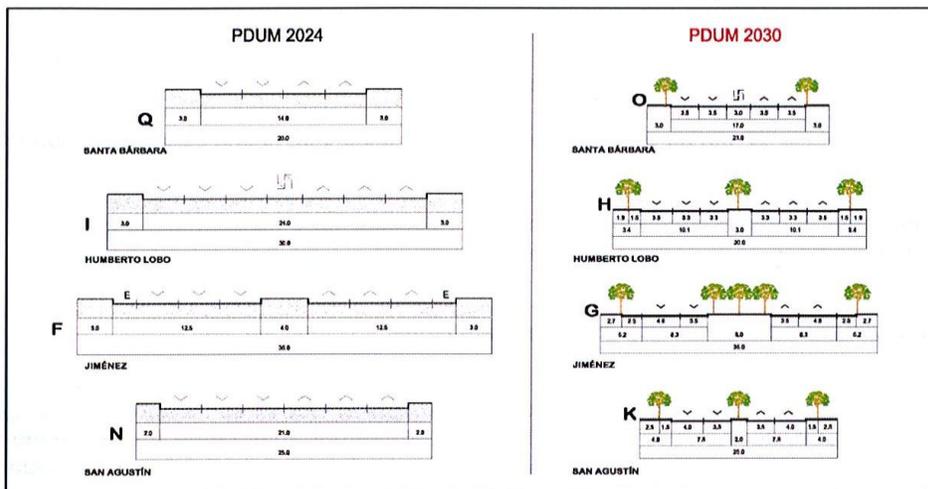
Comparación de algunas secciones de calles existentes y propuestas
